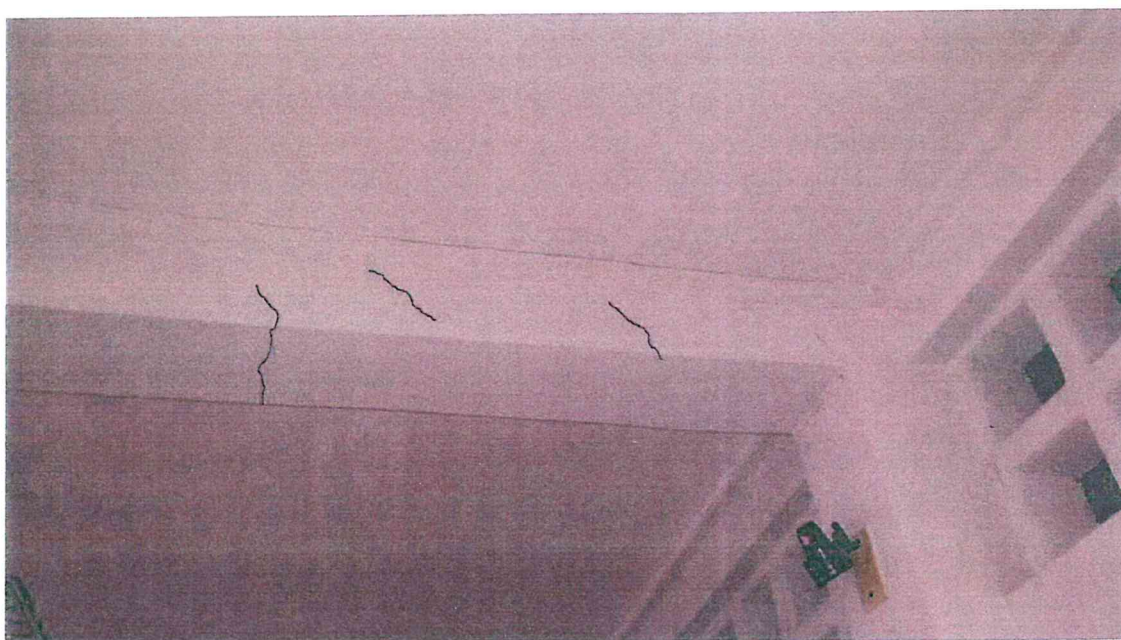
Fissuras na viga abaixo do nível do forro, marcadas realçadas na edição da imagem.
